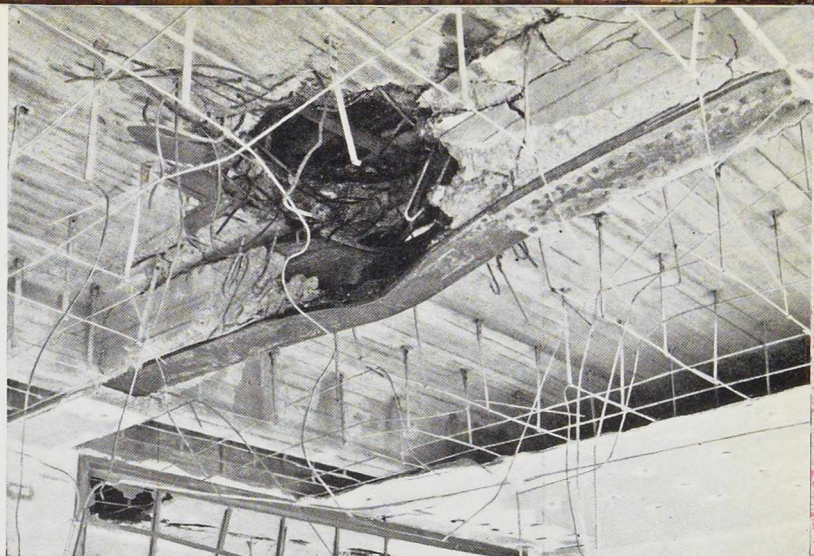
Déformation d'une poutre touchée de plein fouet par une bombe qu'elle a fait ricocher.
